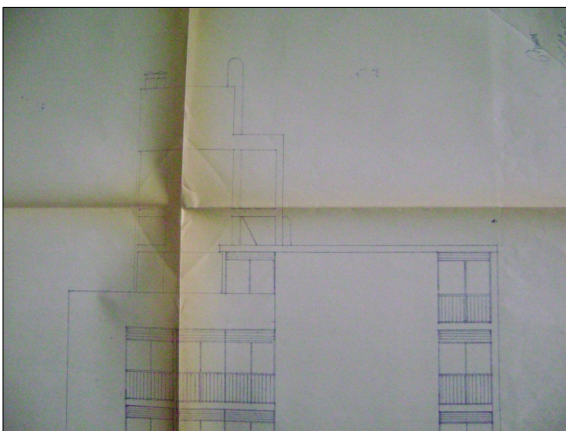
Fotografía de Plano de Arquitectura de Fachada Sur donde se aprecia el Tanque de Agua Elevado
